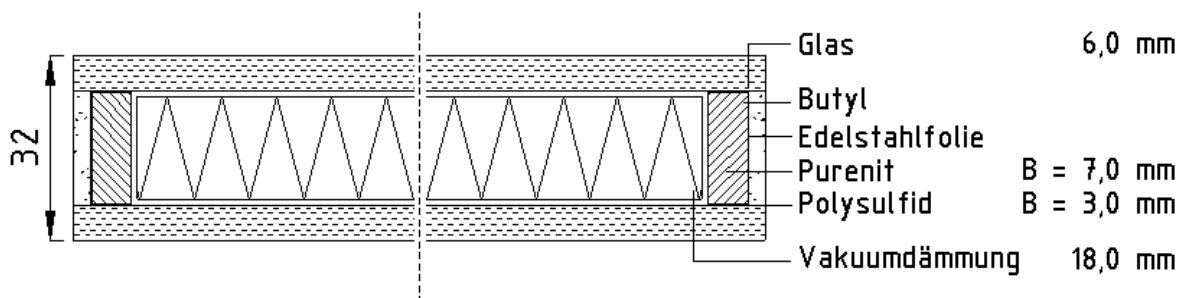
Querschnitt durch ein Fassadenelement. Statt der Glasscheibe wurde bei einigen Brüstungselementen ein 3 mm dickes Aluminiumblech verwendet.
